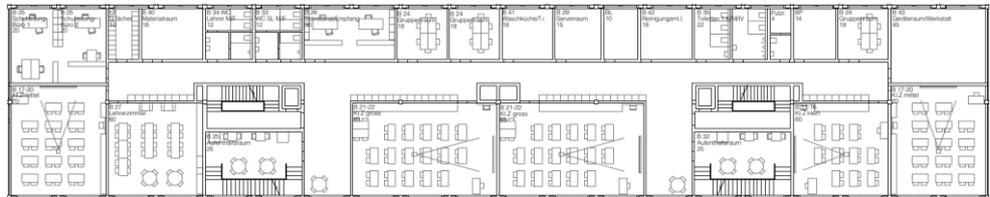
Grundriss 2. Obergeschoss «PORTA SURSILVANA»
